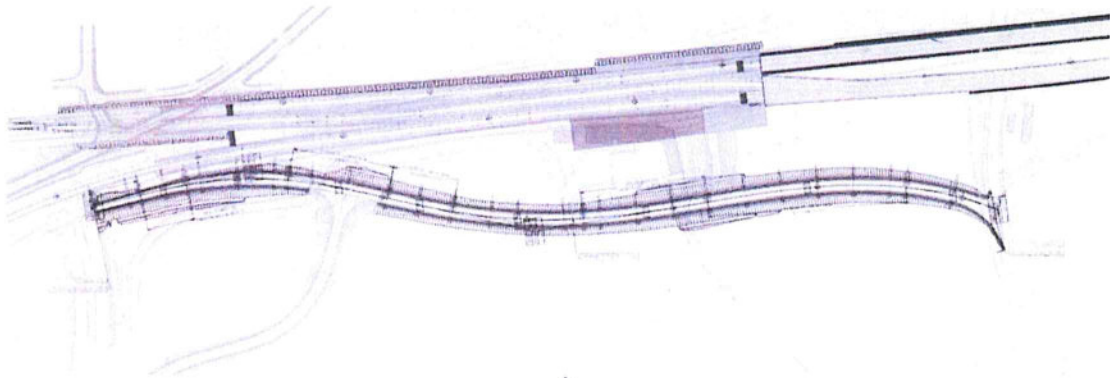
Stralcio planimetrico su rilievo Via della Spianà temporanea.
